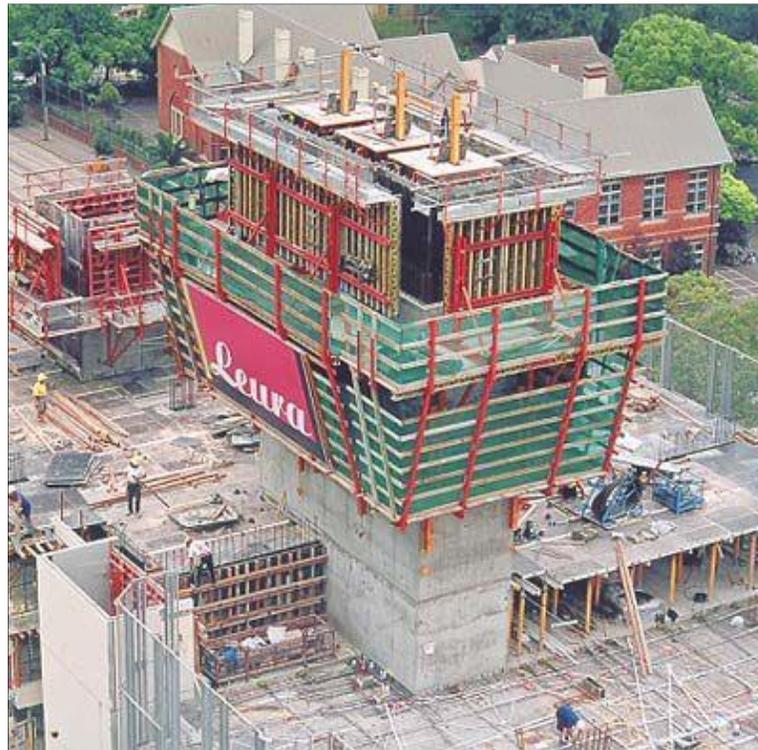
Sistema de encofrado autotrepante para huecos estrechos.
